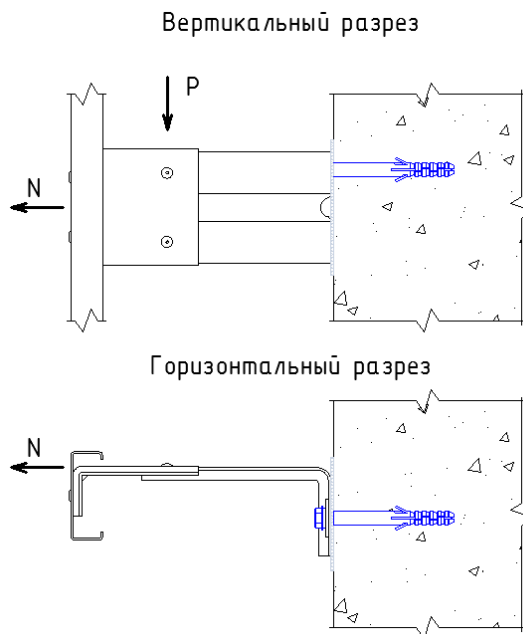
Конструктивная схема для проверки соединения удлинителя с кронштейном
